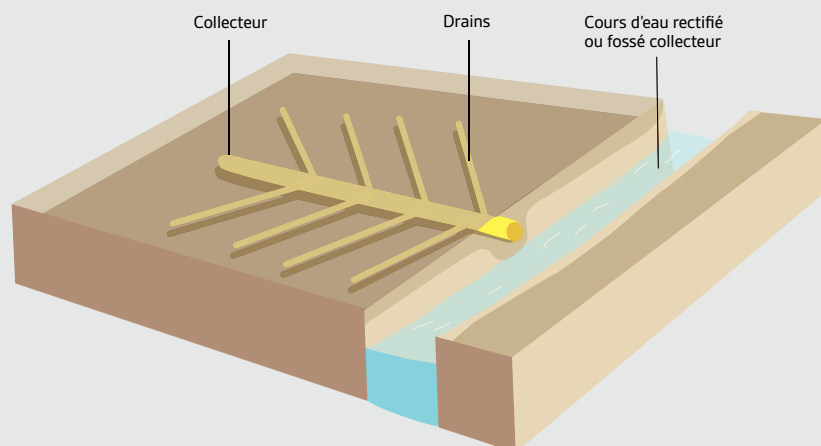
Schéma de principe d'un drainage en arête de poisson.
